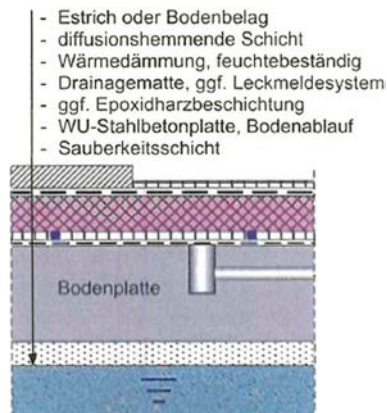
Bodenaufbau mit Drainage, Beanspruchungskategorie 1
